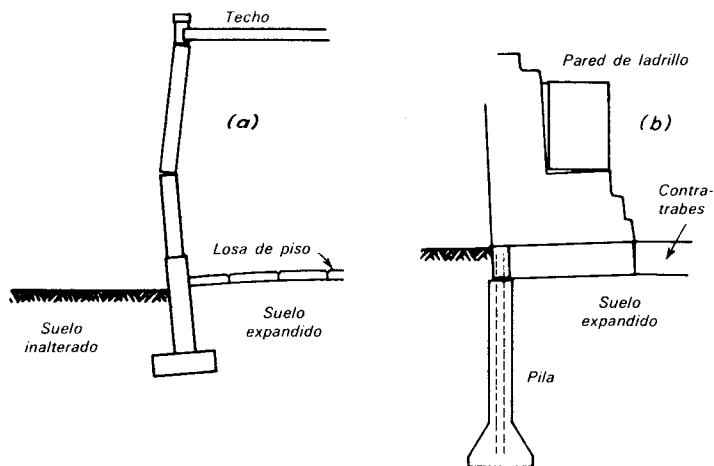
Daños causados por expansión *a*) estructura típica apoyada en zapatas con losa de piso (según Parcher y Means, 1968), y *b*) estructura típica apoyada en pilas con contratraveses en contacto con el suelo expansivo.
